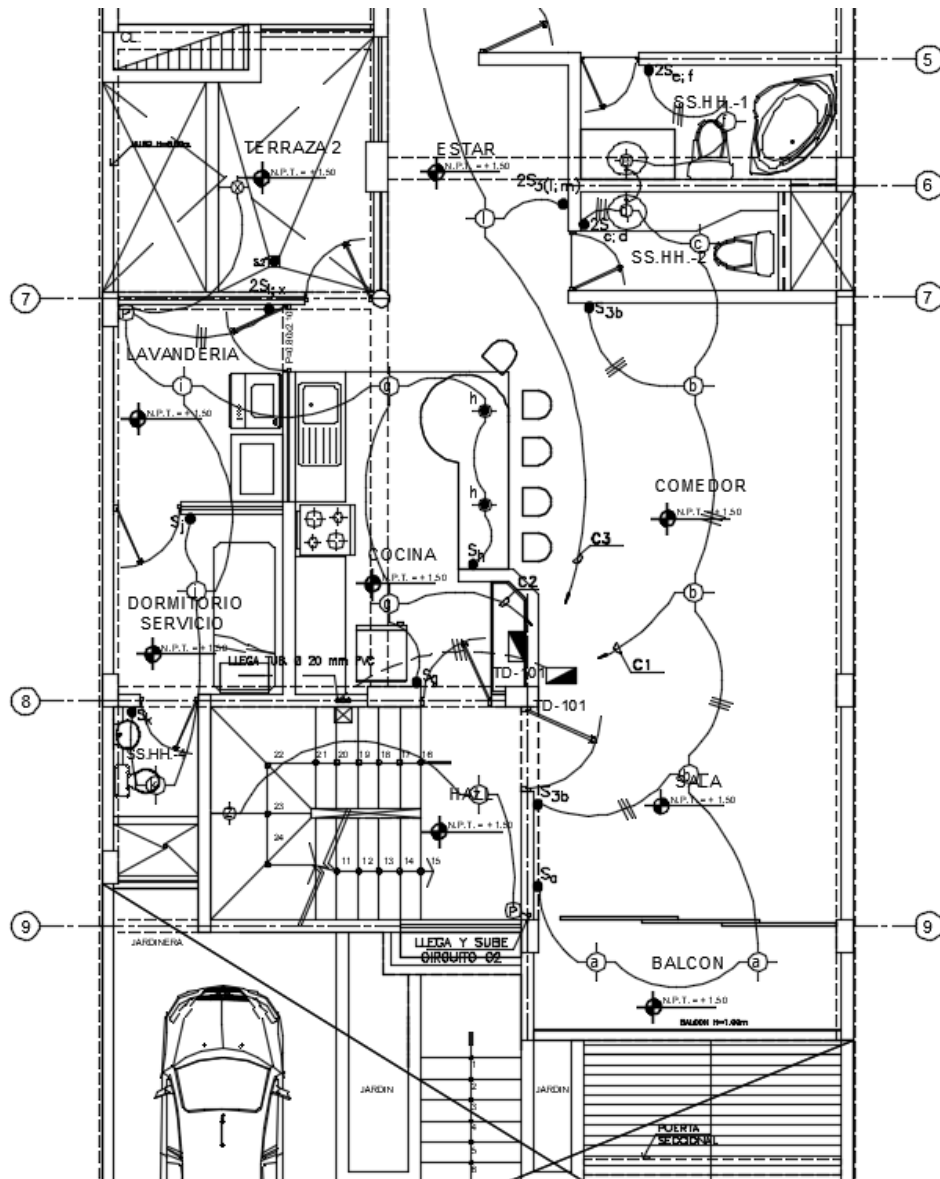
Sección del plano de Instalaciones Eléctricas del Nivel 1
